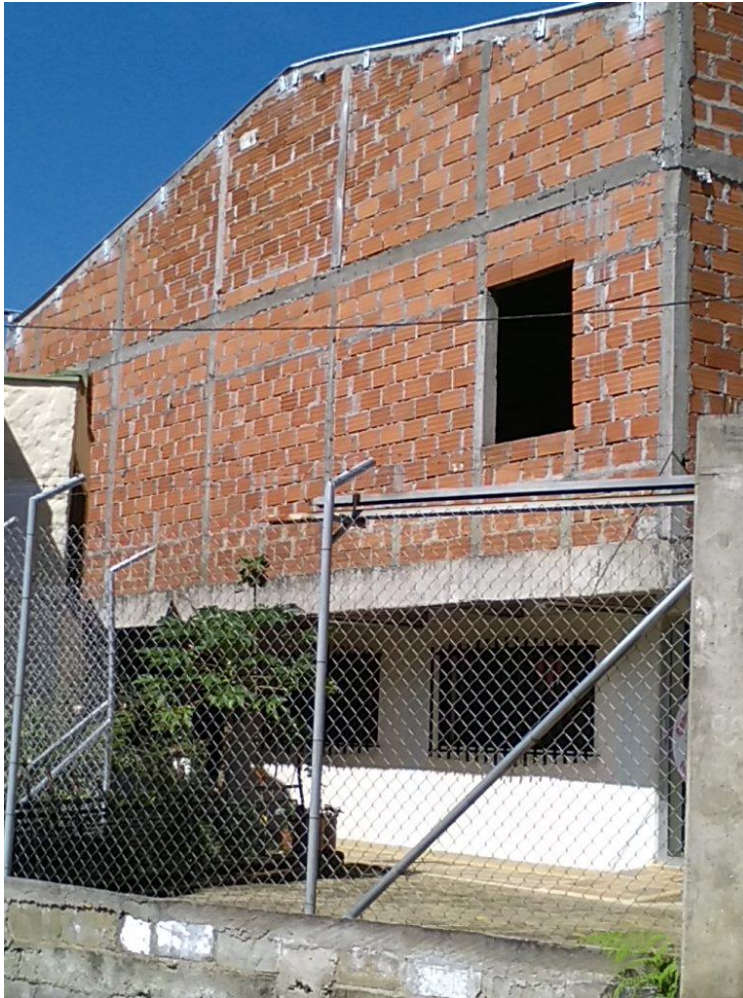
Tipología estructuras con confinamiento deficiente e híbridas (D). Estructura ubicada en el polígono La Sierra.
